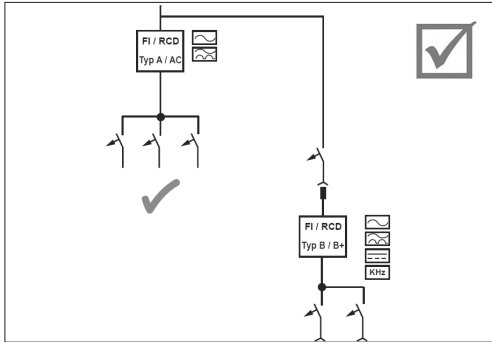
Fachgerechte Elektroinstallation (Hausinstallation)
